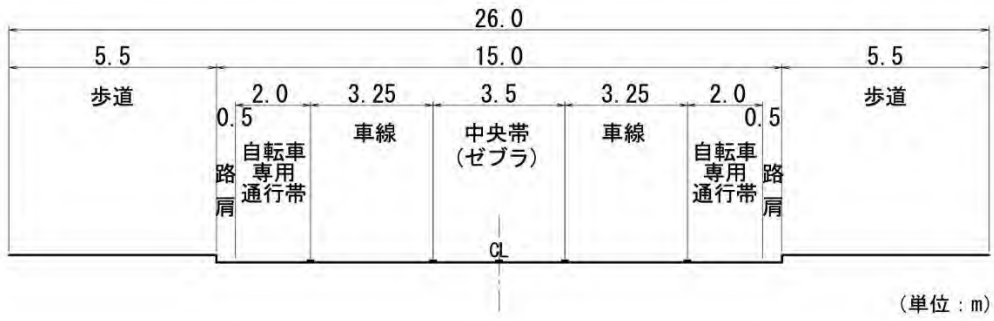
(1) 区域内道路 1 号～3 号の標準断面図
